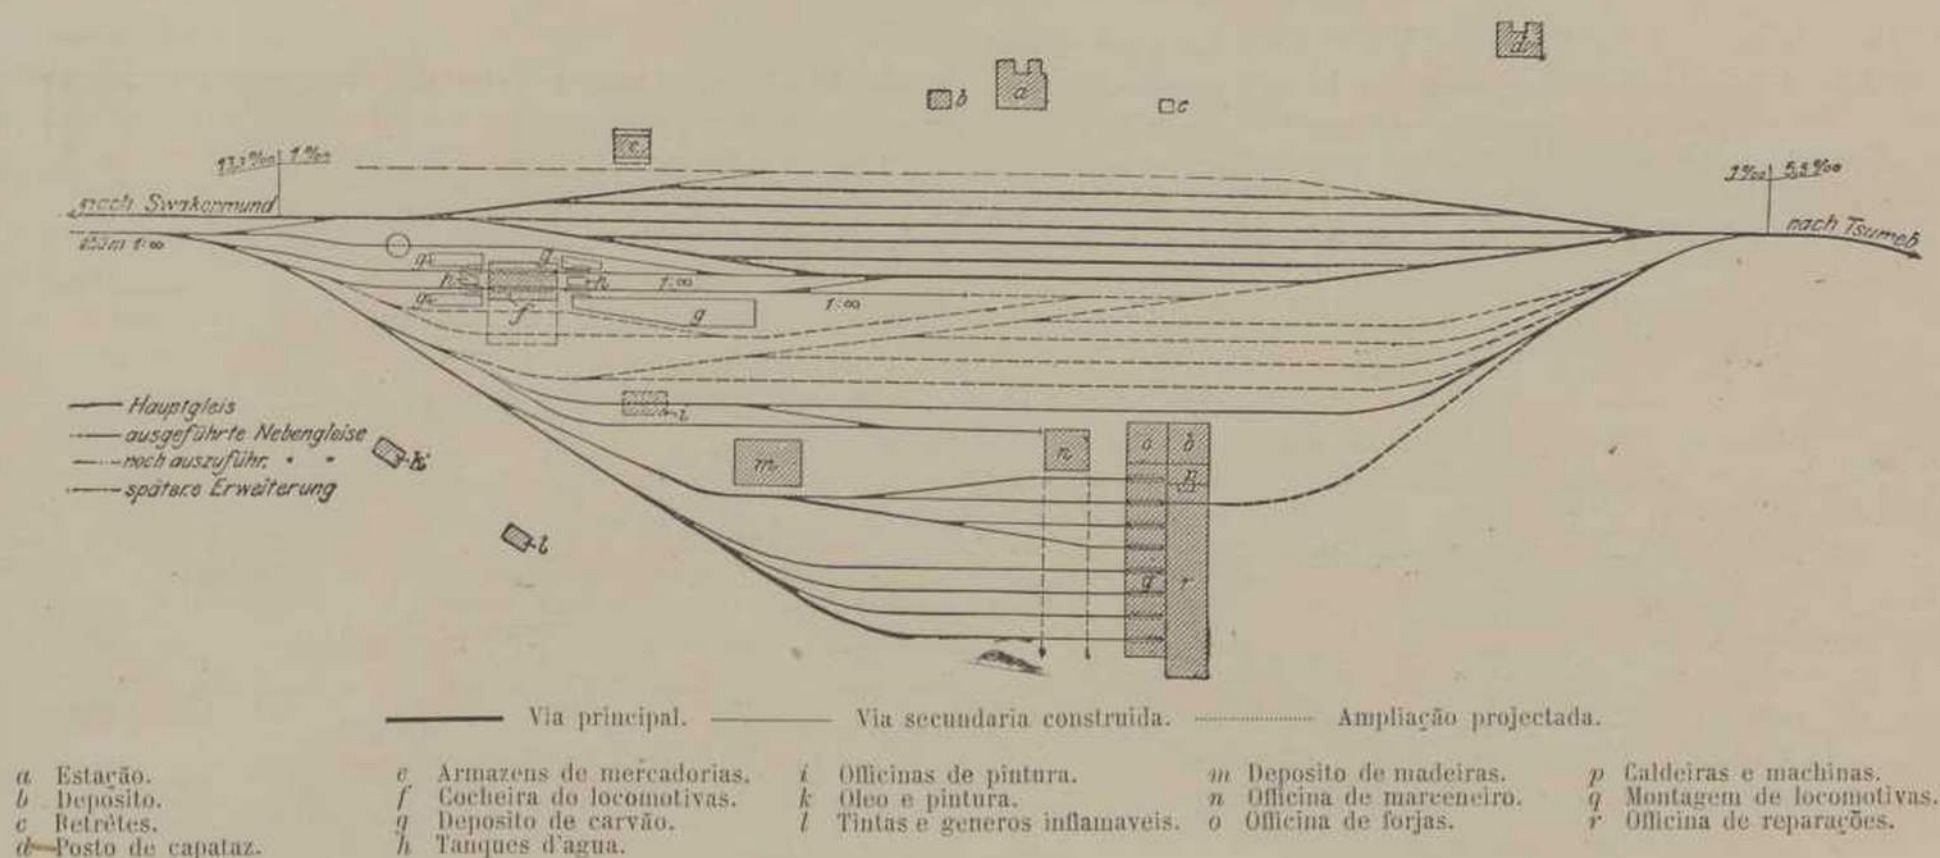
PLANTA DA ESTAÇÃO DE USAKOS
